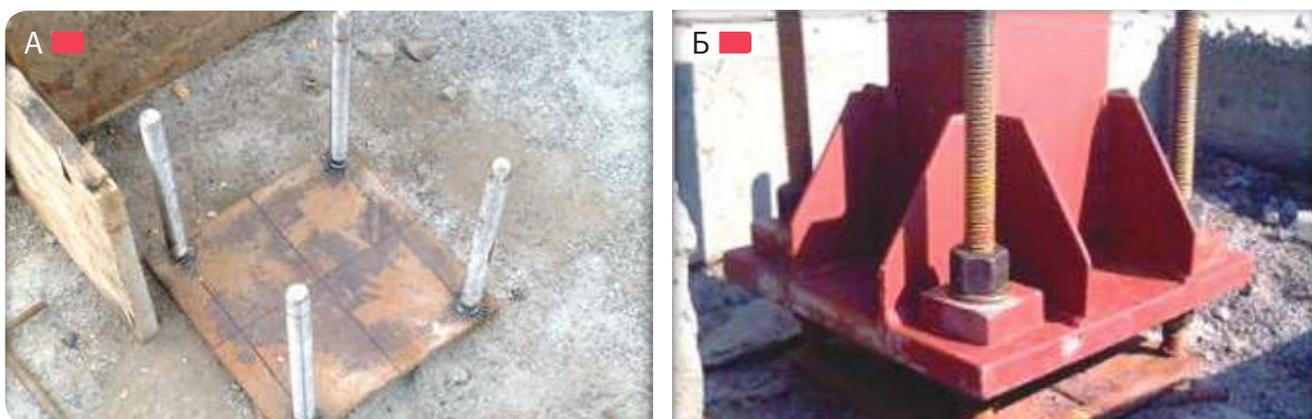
А – приваривание анкерных болтов к существующей закладной детали в бетонном фундаменте; Б – установка колонны на полученные анкерные болты
